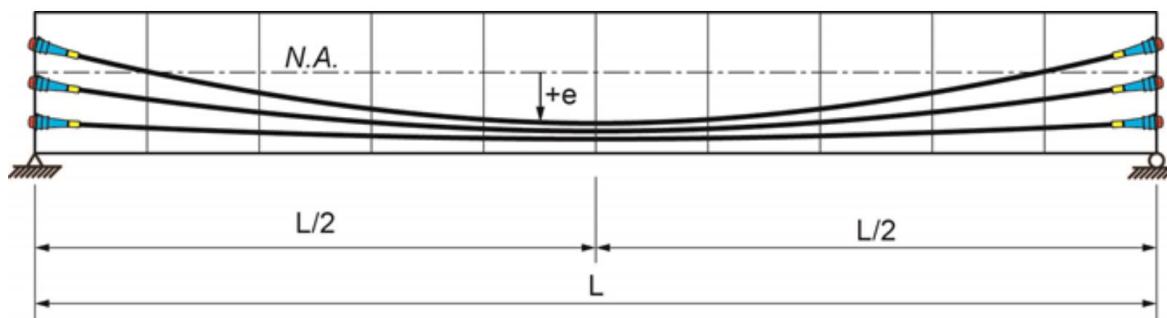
Trazado de cable postesado en viga simplemente apoyada (Fuente: [12]).
